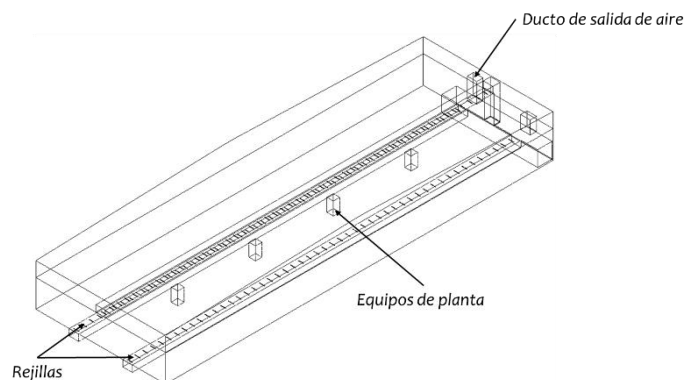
Módulo de climatización convencional de la planta de hilandería.
